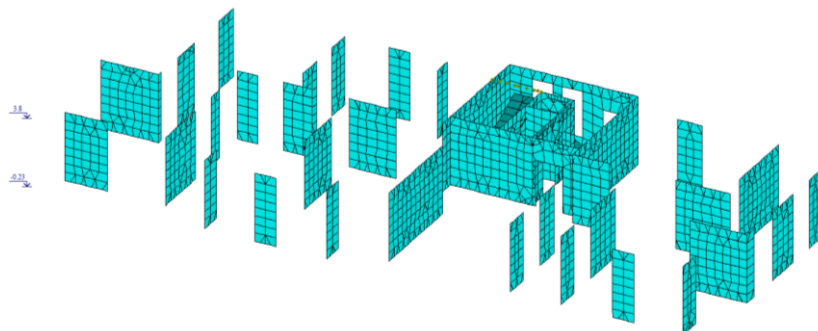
Схема расположения вертикальных несущих конструкций типового этажа
